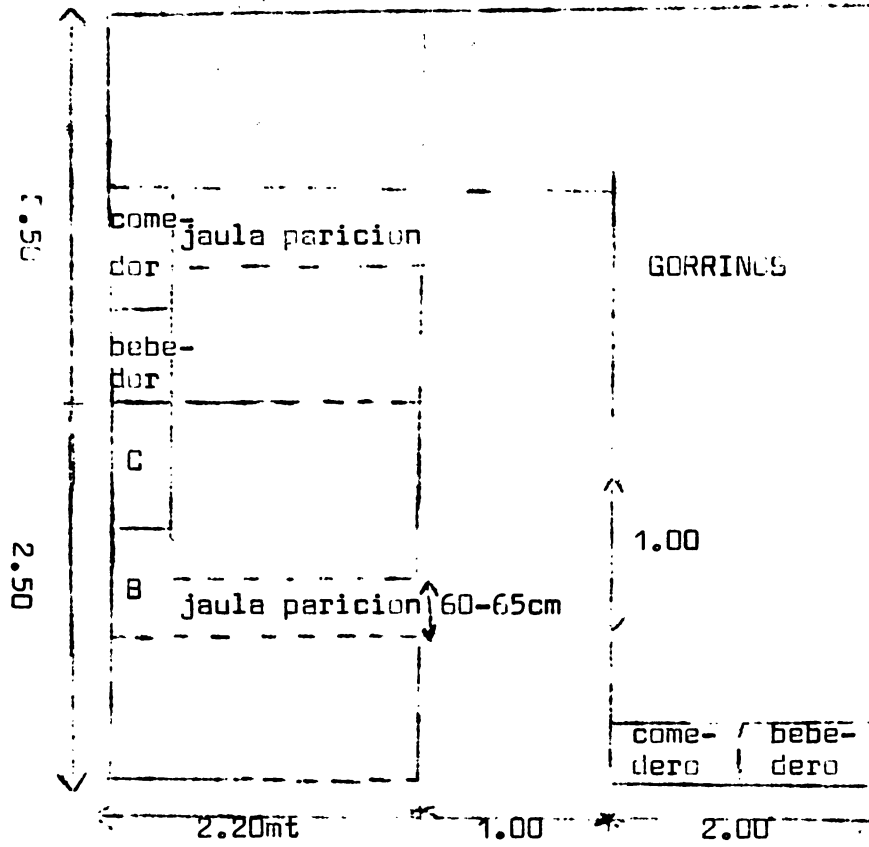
PLANTA POR VERIZA DE LOS COLONOS
